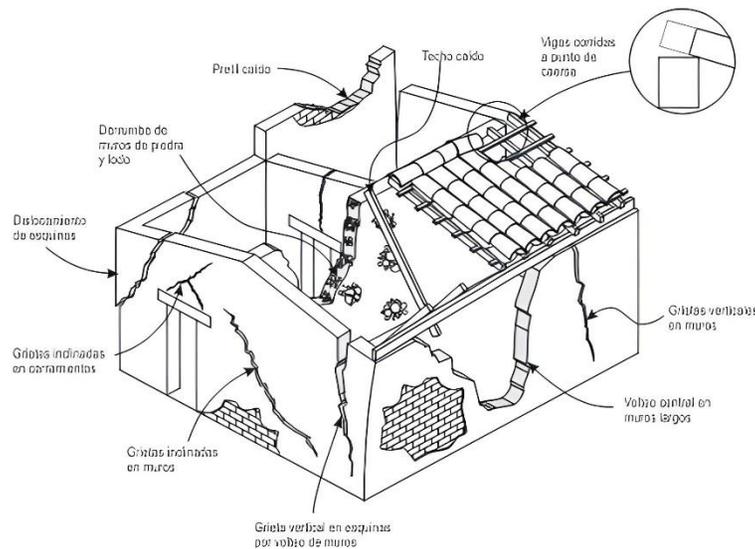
Daños comunes en viviendas rurales. Fuente: (Flores et al., 2001)
